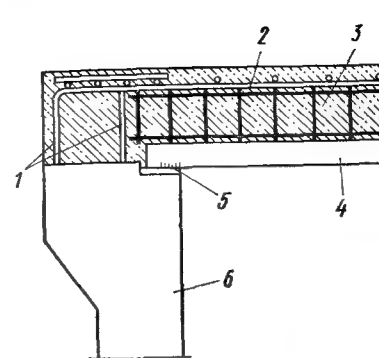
Узел сопряжения стеновой панели со сборно-монолитным покрытием
